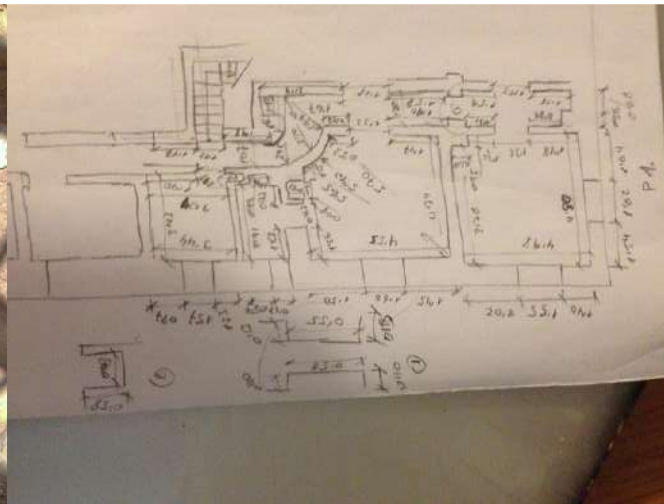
Croquis in situ. Fuente: Elaboración propia
